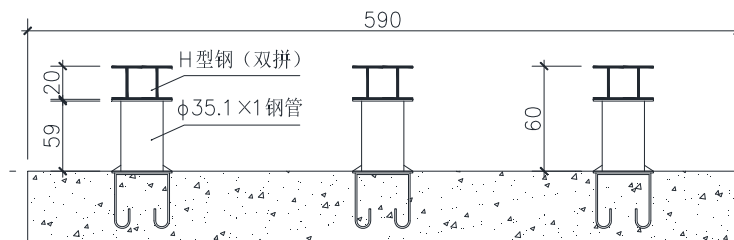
制梁台座中部基础横断面示意图（单位：cm）
